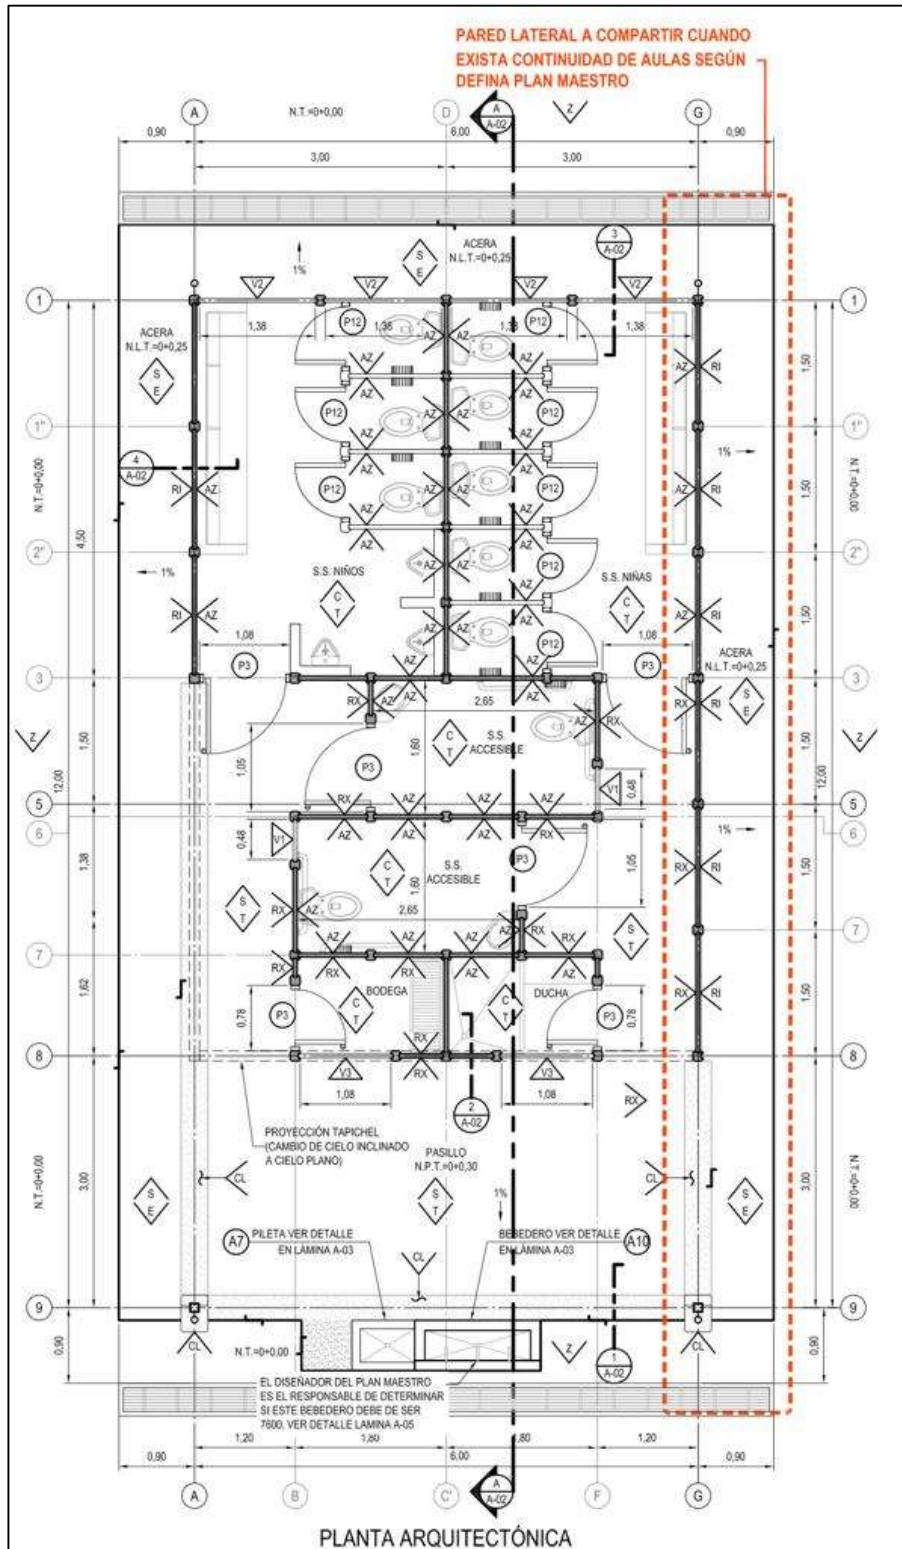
Vista en planta de la Batería Sanitaria Tipo 1 72 m²
